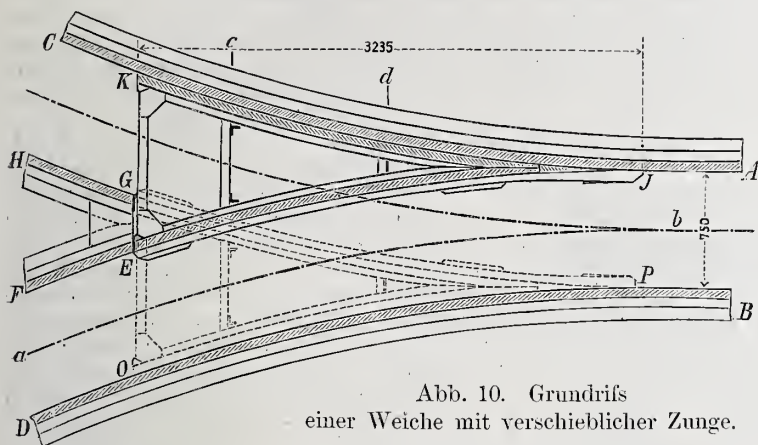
Grundriss einer Weiche mit verschieblicher Zunge.
